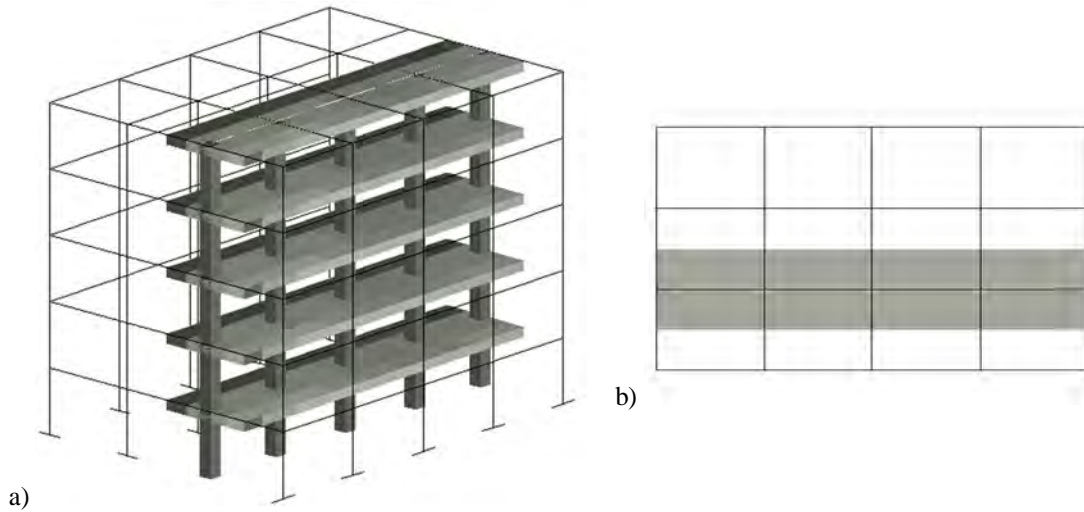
Marco equivalente: a) vista en 3D y b) vista en planta.
